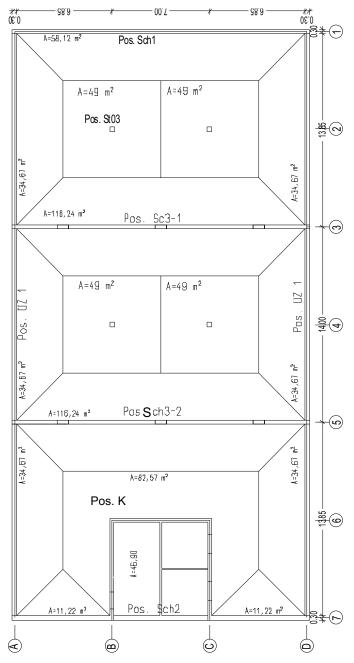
Lasteinzugsfläche [Pos.Decke]
